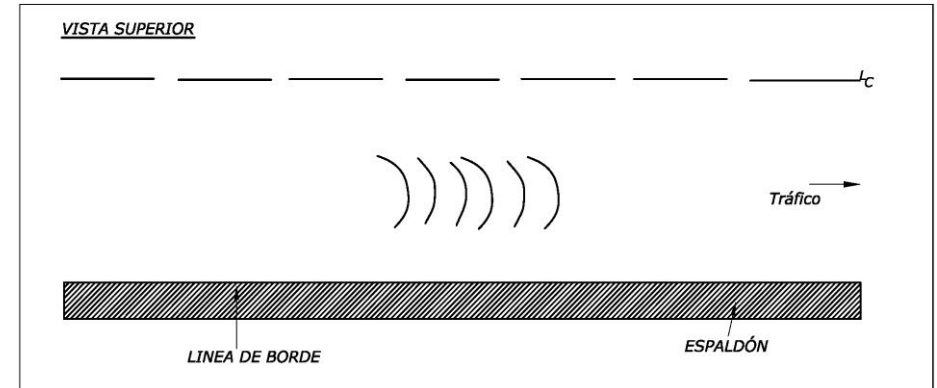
Esquema Grietas en Arco – Pavimento Flexible
